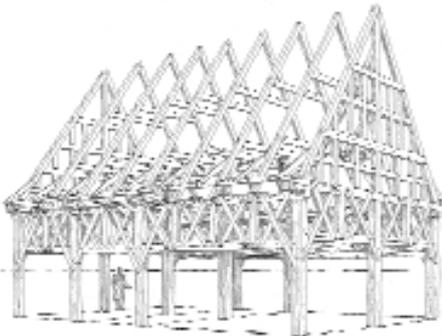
Sparrendach mit Kehlbalken, einfach stehendem Stuhl und Umgebinderkonstruktion [5]
